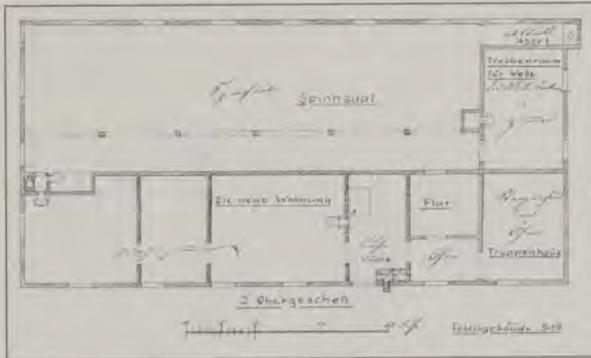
Der Grundriß-Plan vom 2. Obergeschoß enthält die 1849 eingerichtete neue Wohnung. (Er wurde durch Beschriftung ergänzt.)
